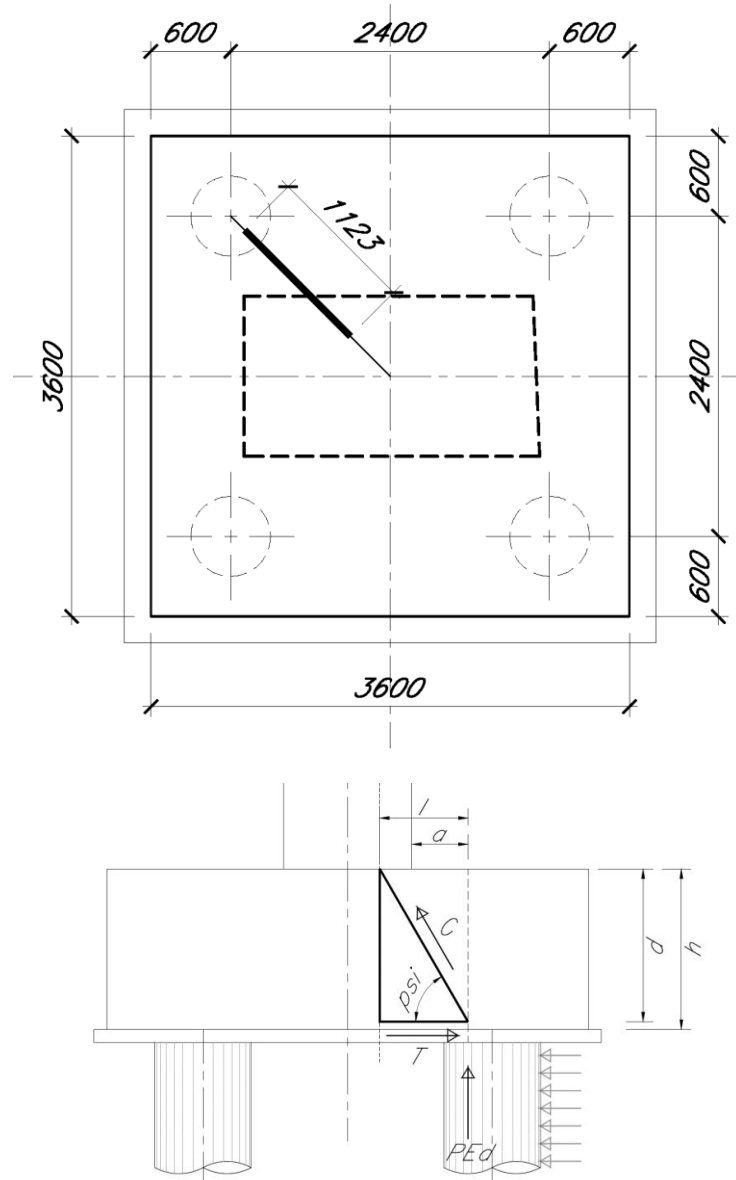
Tirante puntone - Biella compressa di calcestruzzo C e tirante di armatura T
